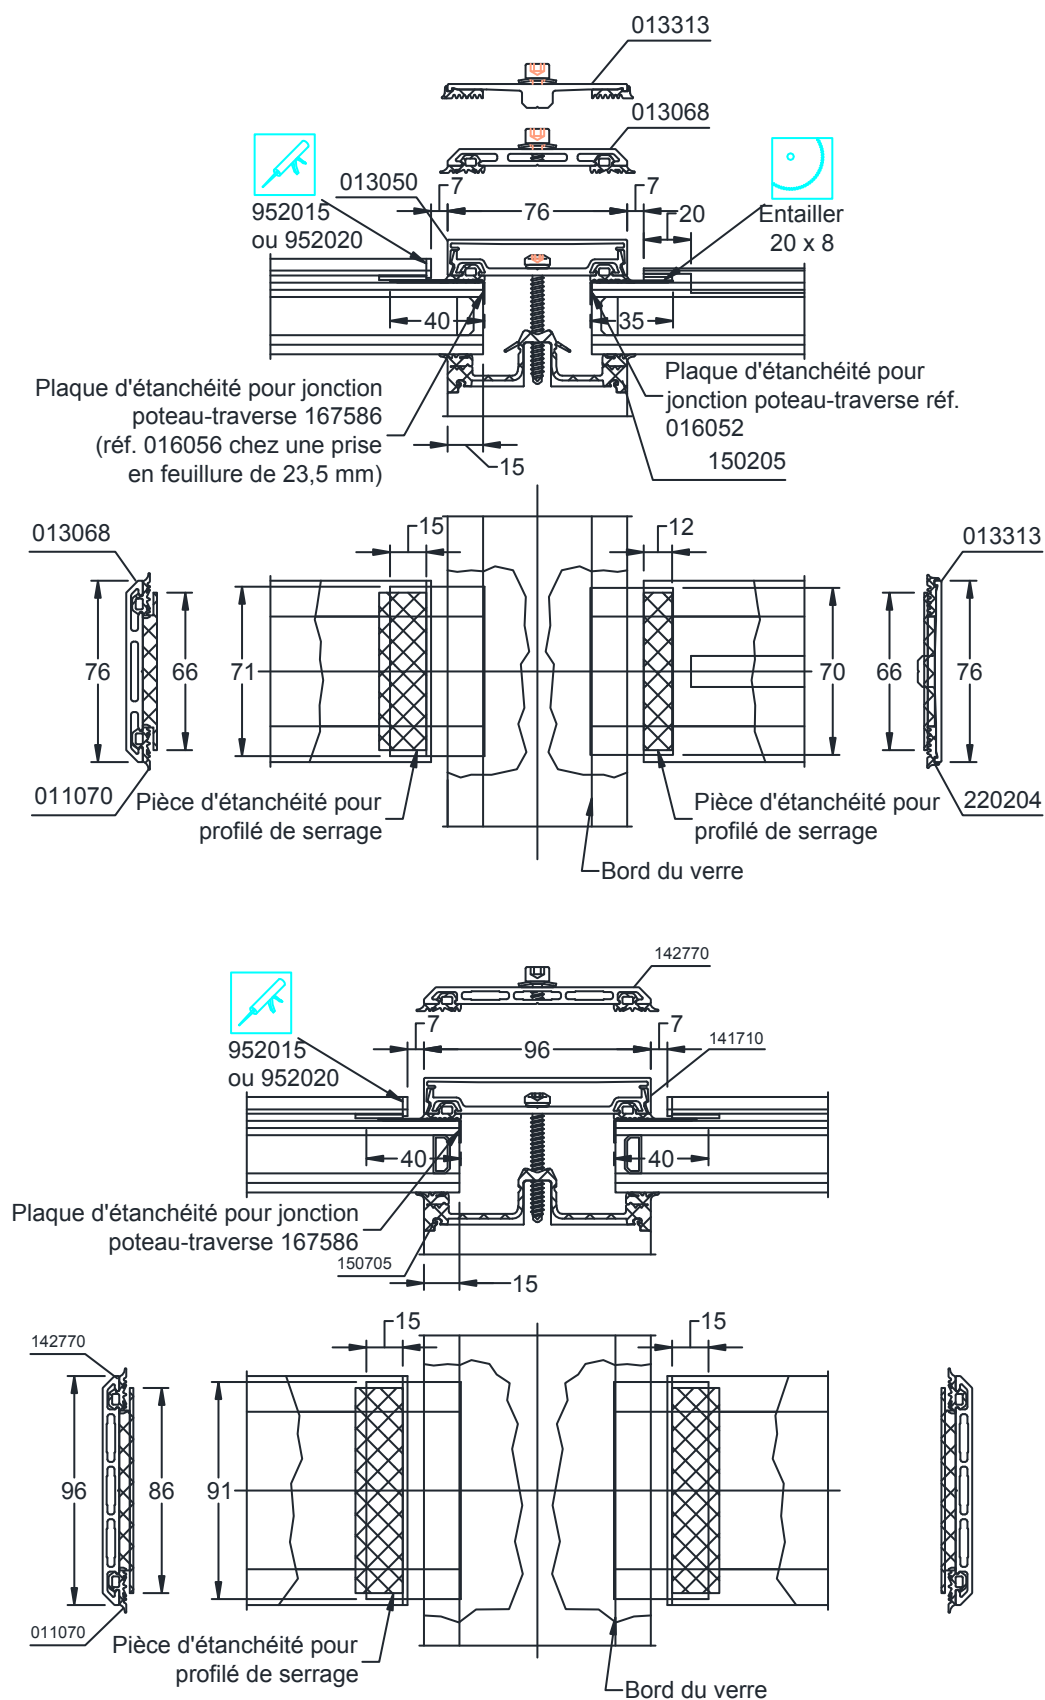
Montage des plaques d'étanchéité de croisement et des pièces d'étanchéité de profilé de serrage : séries 76 et 96
